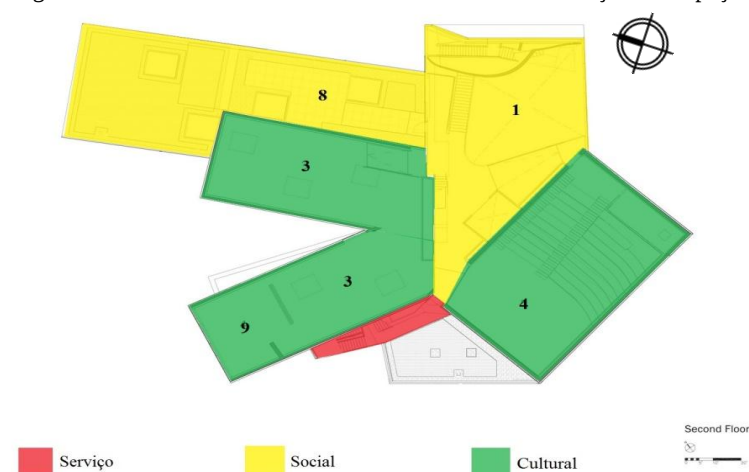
Planta Baixa Térreo – Zoneamento e definição dos espaços.
